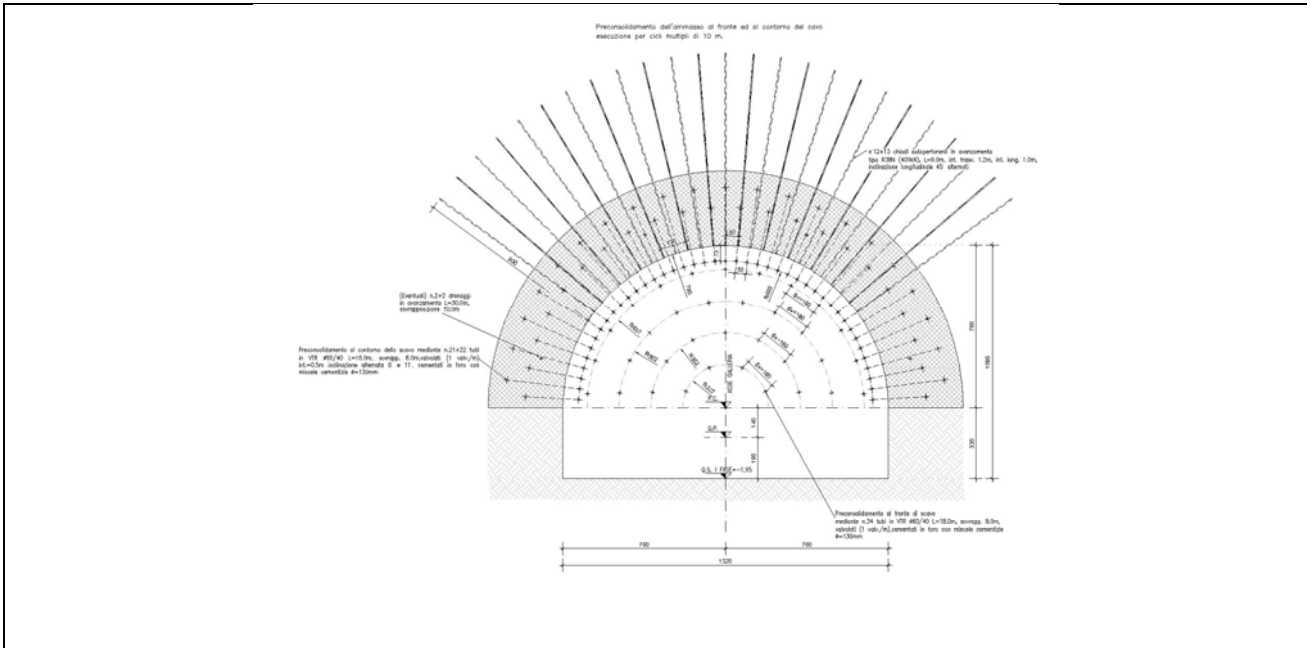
Sezione di scavo tipo GD-B2 - Sezione trasversale
